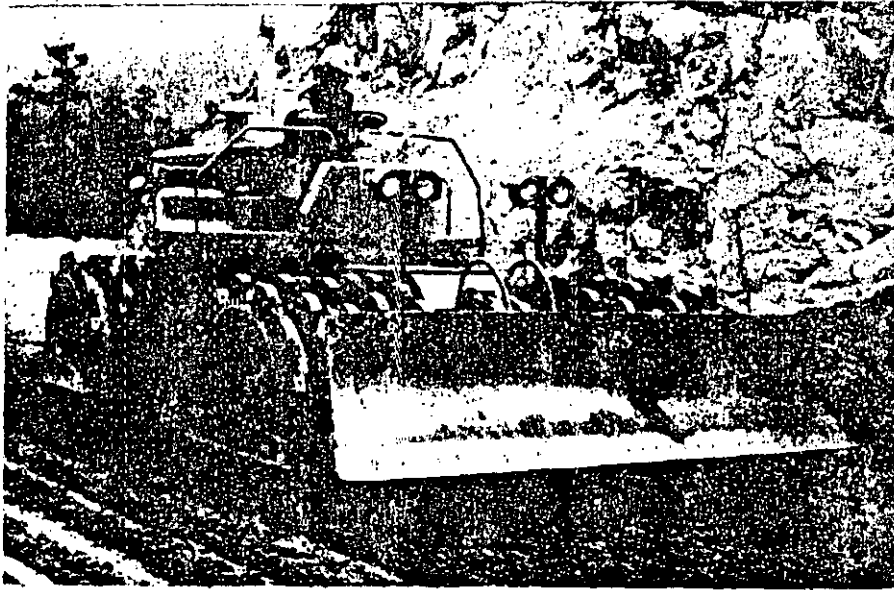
RODILLO DE IMPACTO (TAMPING-ROLLER)
